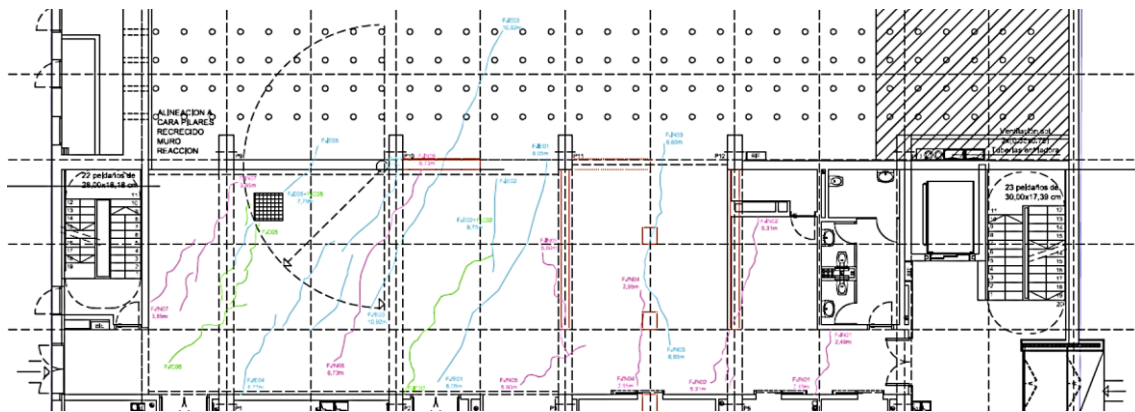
Levantamiento de fisuras en la losa de planta baja a 25/01/2013 (AICEQUIP, (2013)).
